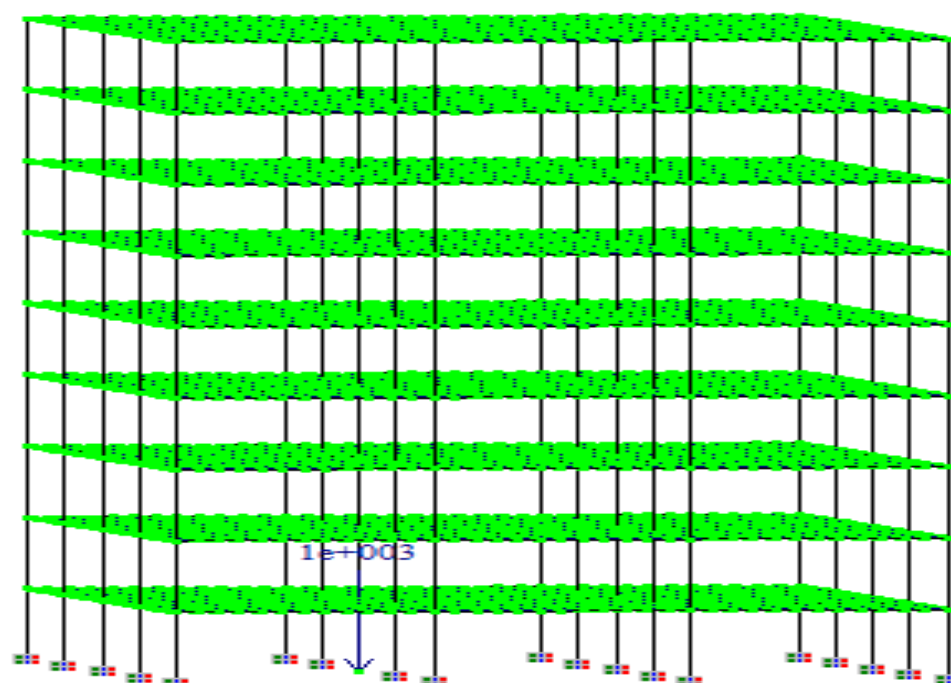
Schéma illustratif du modèle d'étude du bâtiment avec planchers en hourdis à 9 niveaux avec un chargement vertical sur le poteau intermédiaire
